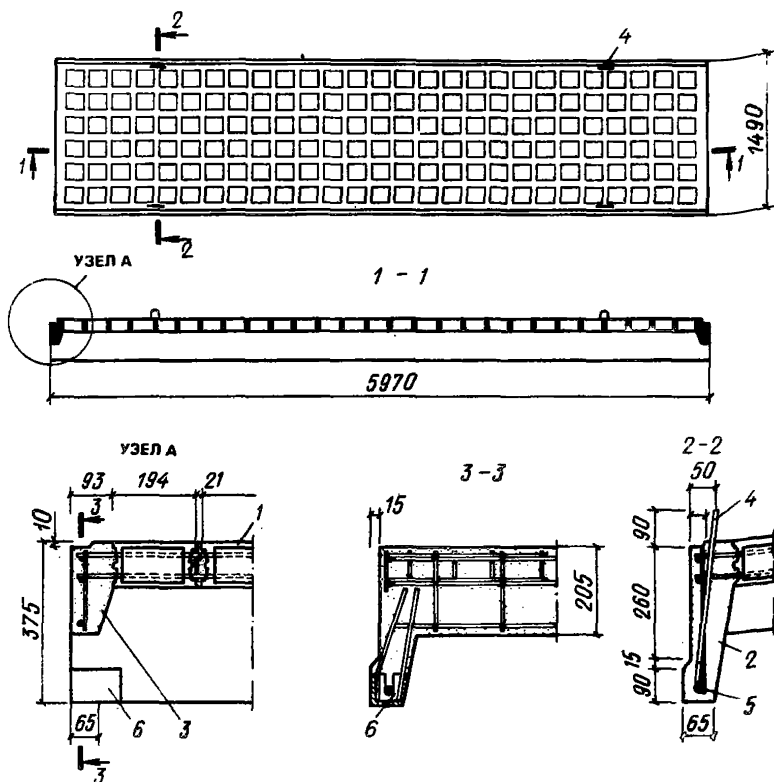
Стекложелезобетонная ребристая панель покрытия с преднапряженной арматурой
